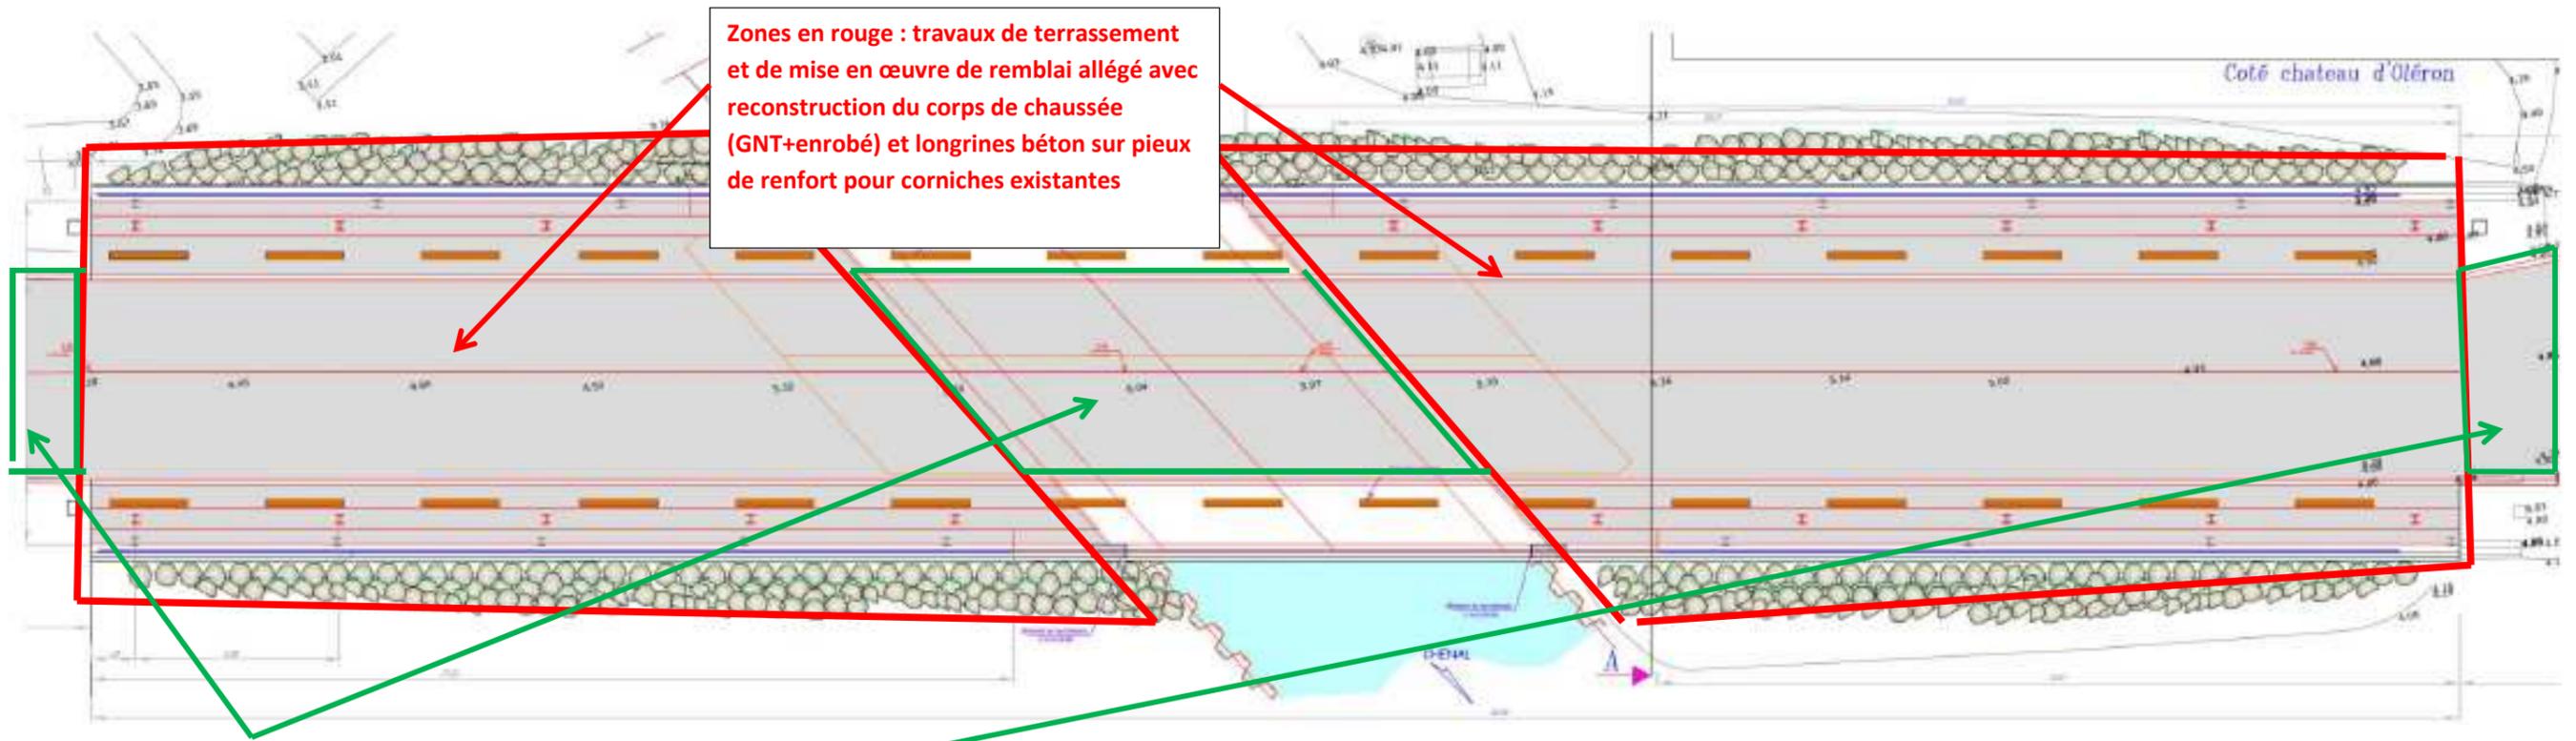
vue en plan de l'ouvrage solution 1 remblai allégé
